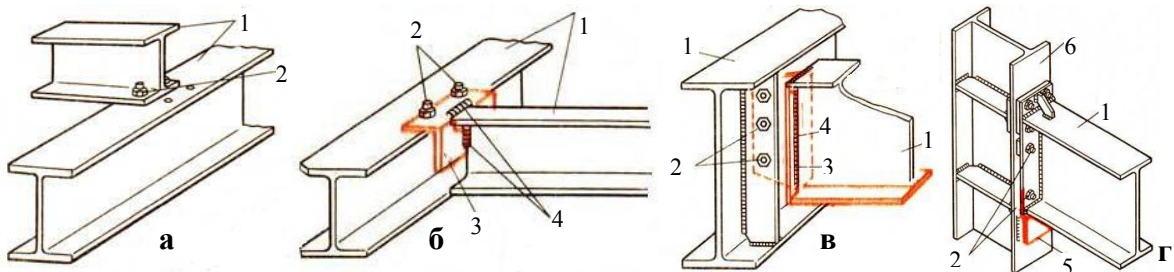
Болтові з'єднання сталевих конструкцій: а – під час поверхового обпирання балок; б, в – на опорних кутках; г – із обпертям на планку; 1 – балки; 2 – болти; 3 – опорний кут; 4 – зварний шов, що з'єднує опорний кут і балку; 5 – опорна планка; 6 – колона
